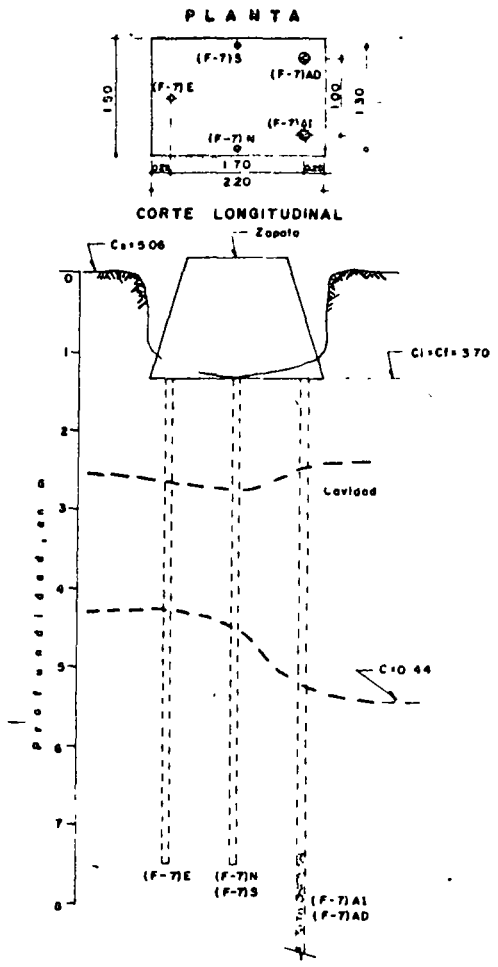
Cavidad de grandes dimensiones bajo la zapata F8 de la Fábrica 1.
